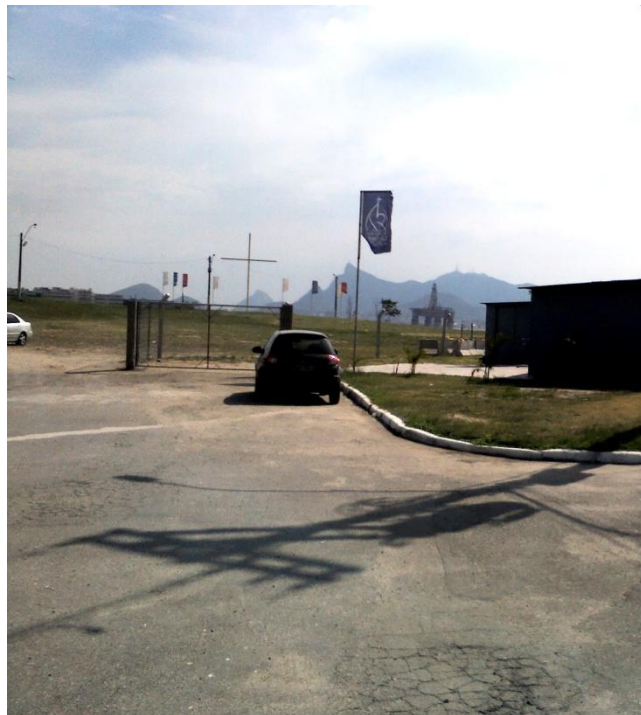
Local de construção da Catedral Católica. Fonte: Foto do autor.
